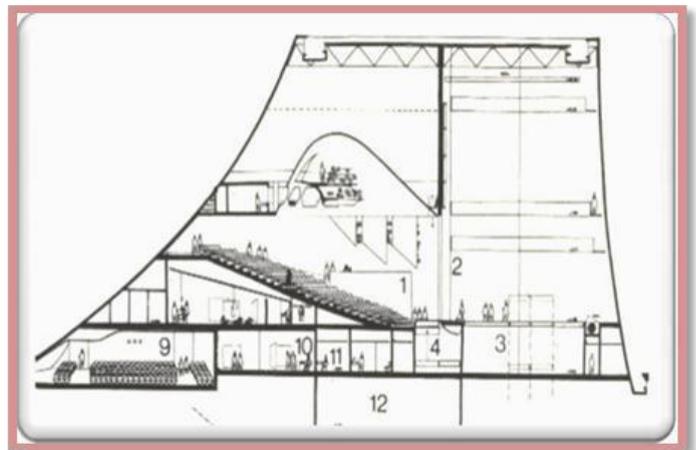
Coupe transversale sur le plan du niveau bas du petit balcon/Source :fr.wikiarquitectura .com
